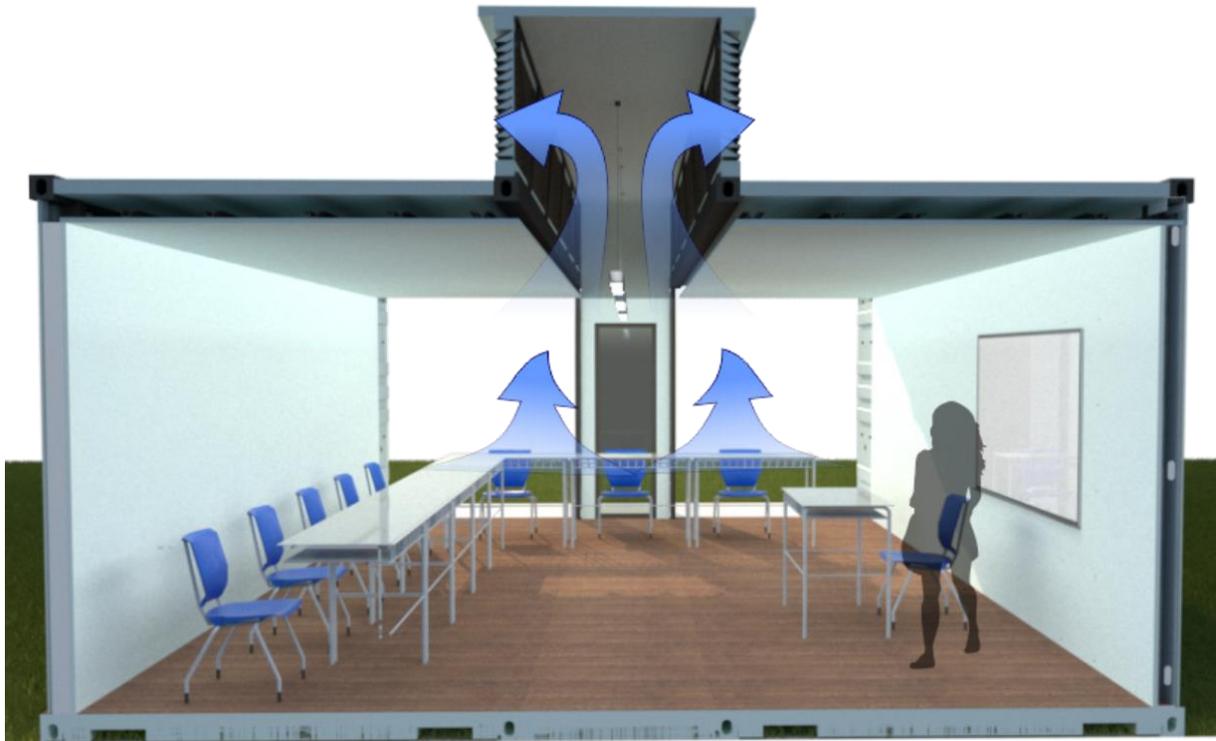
Corte transversal de módulos tipo, en preparatoria transitoria Tezonco. Ventilación cruzada.
